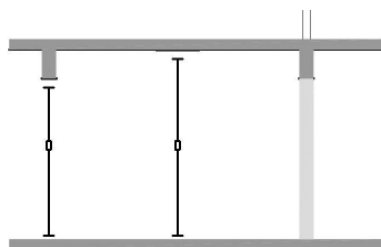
figura esquemática do reescoramento e vigamento dos painéis das lajes
